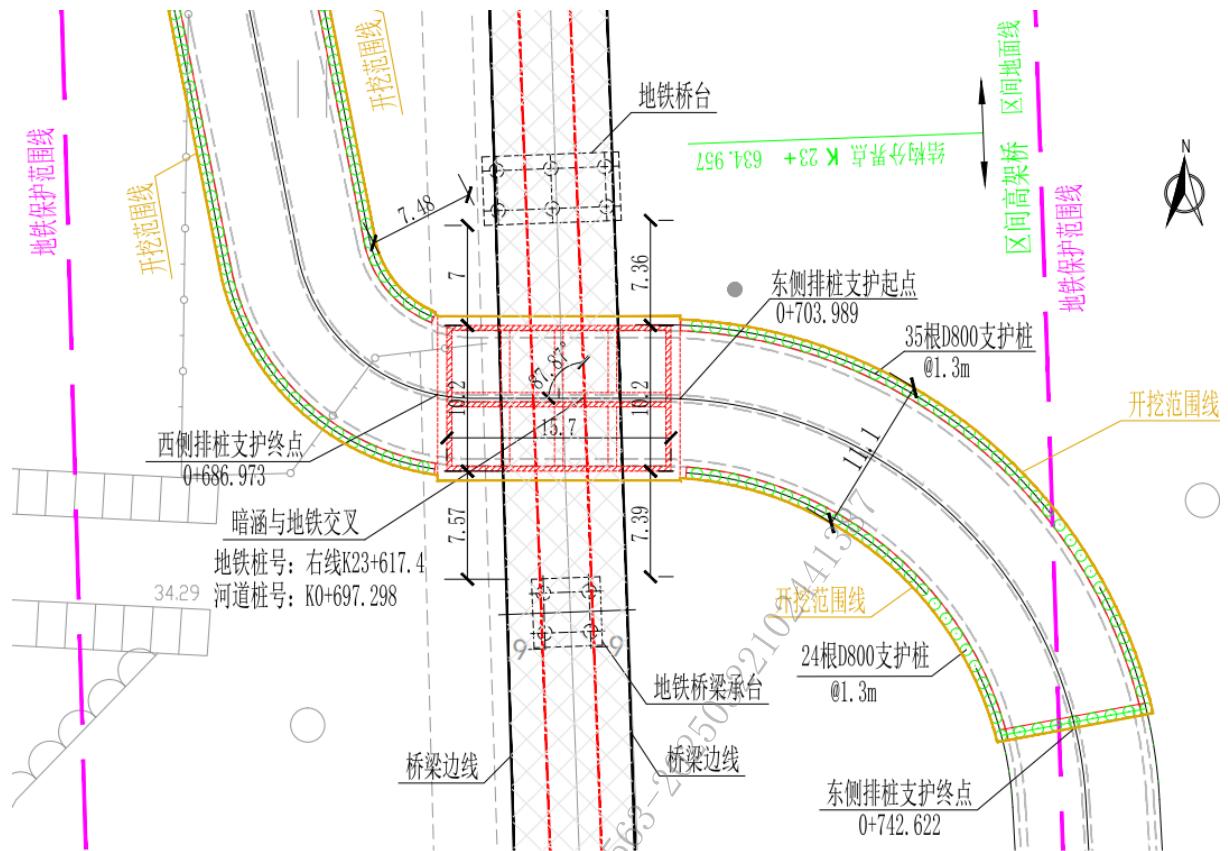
地铁 5 号线正下方倒挂井壁基坑平面图
